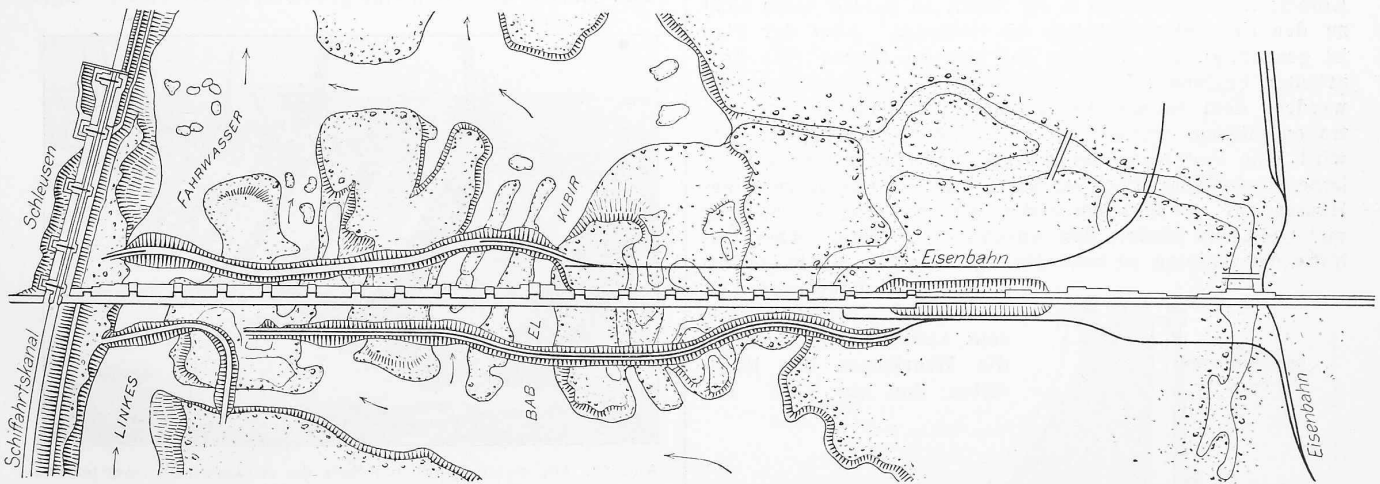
Lageplan des Assuan-Staudammes. — Masstab 1 : 10000.
